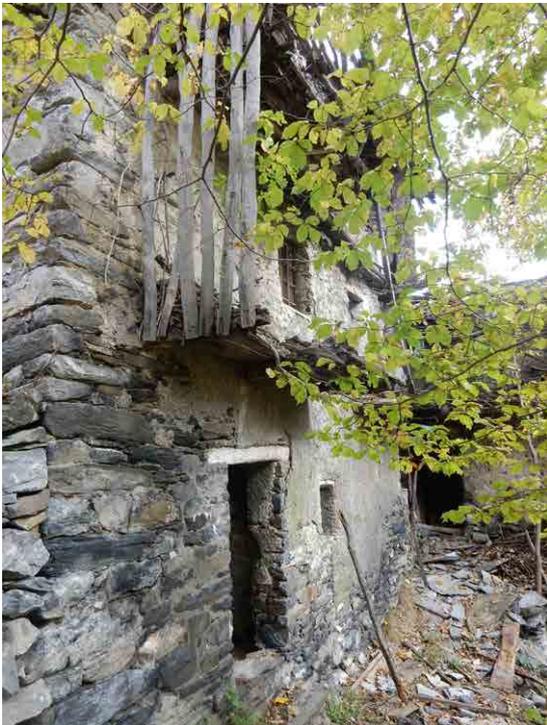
| Balcone con parapetto compatto laterale di protezione (2019)
